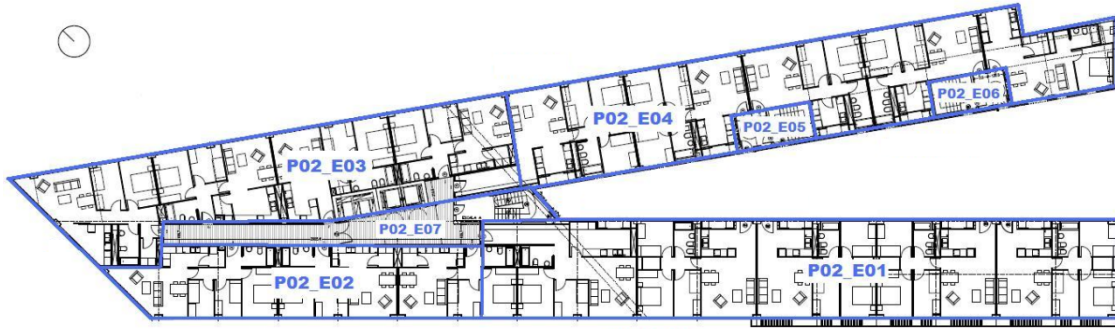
Espacios plantas primera y segunda. Bloque de viviendas en el 22@.
